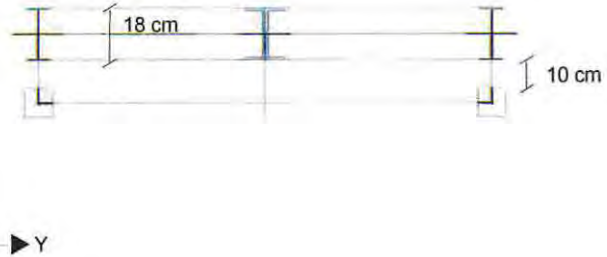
Modelación de conexión del refuerzo con columna de fachada.
